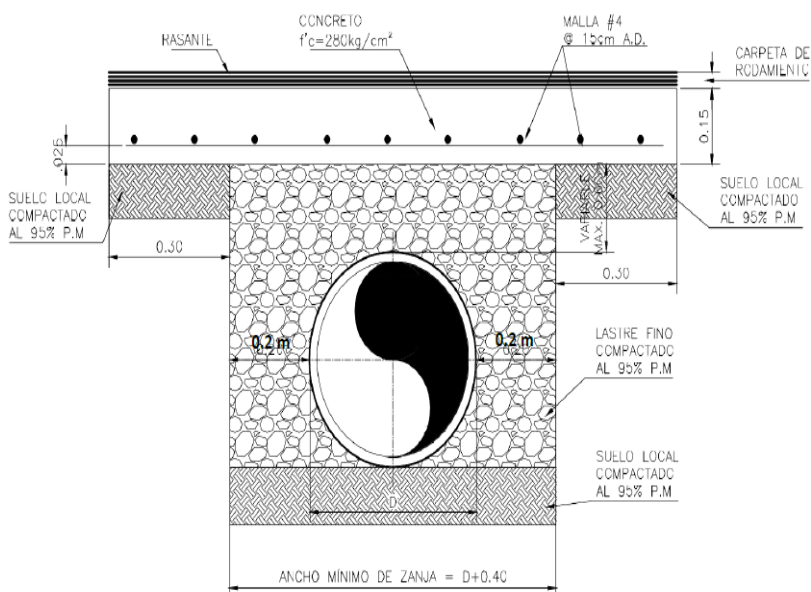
Perfil con especificación de colocación de tubería pluvial
